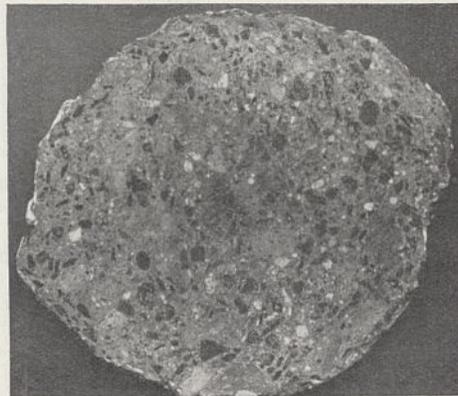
Polierter Querschnitt eines Straußschen Betonpfahles.
